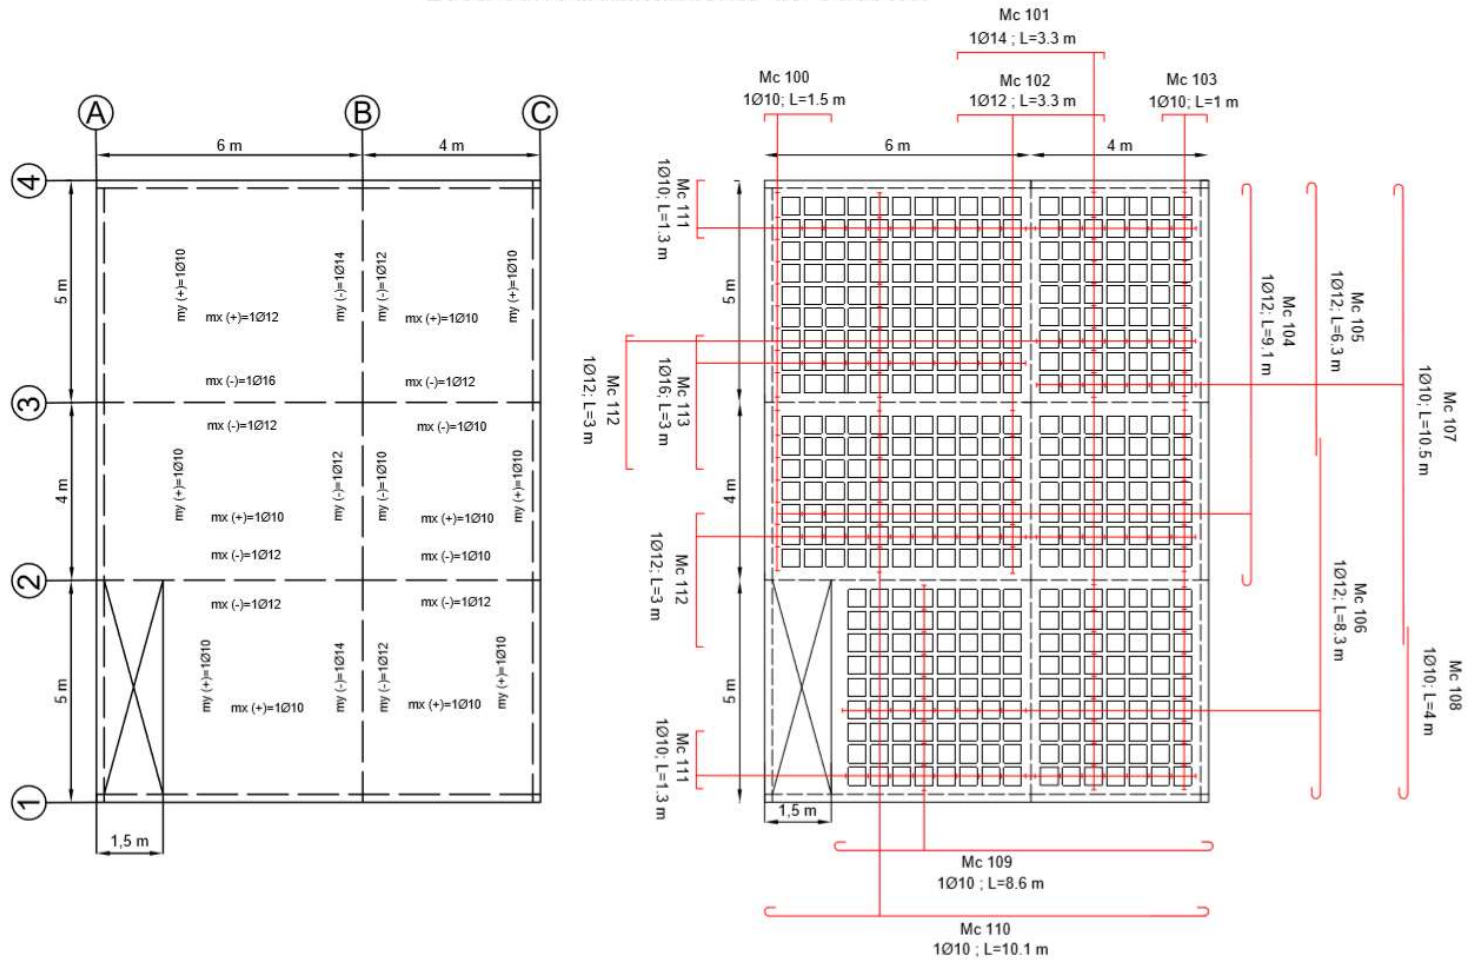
Armadura y distribución de alivianamientos con casetón plástico.
